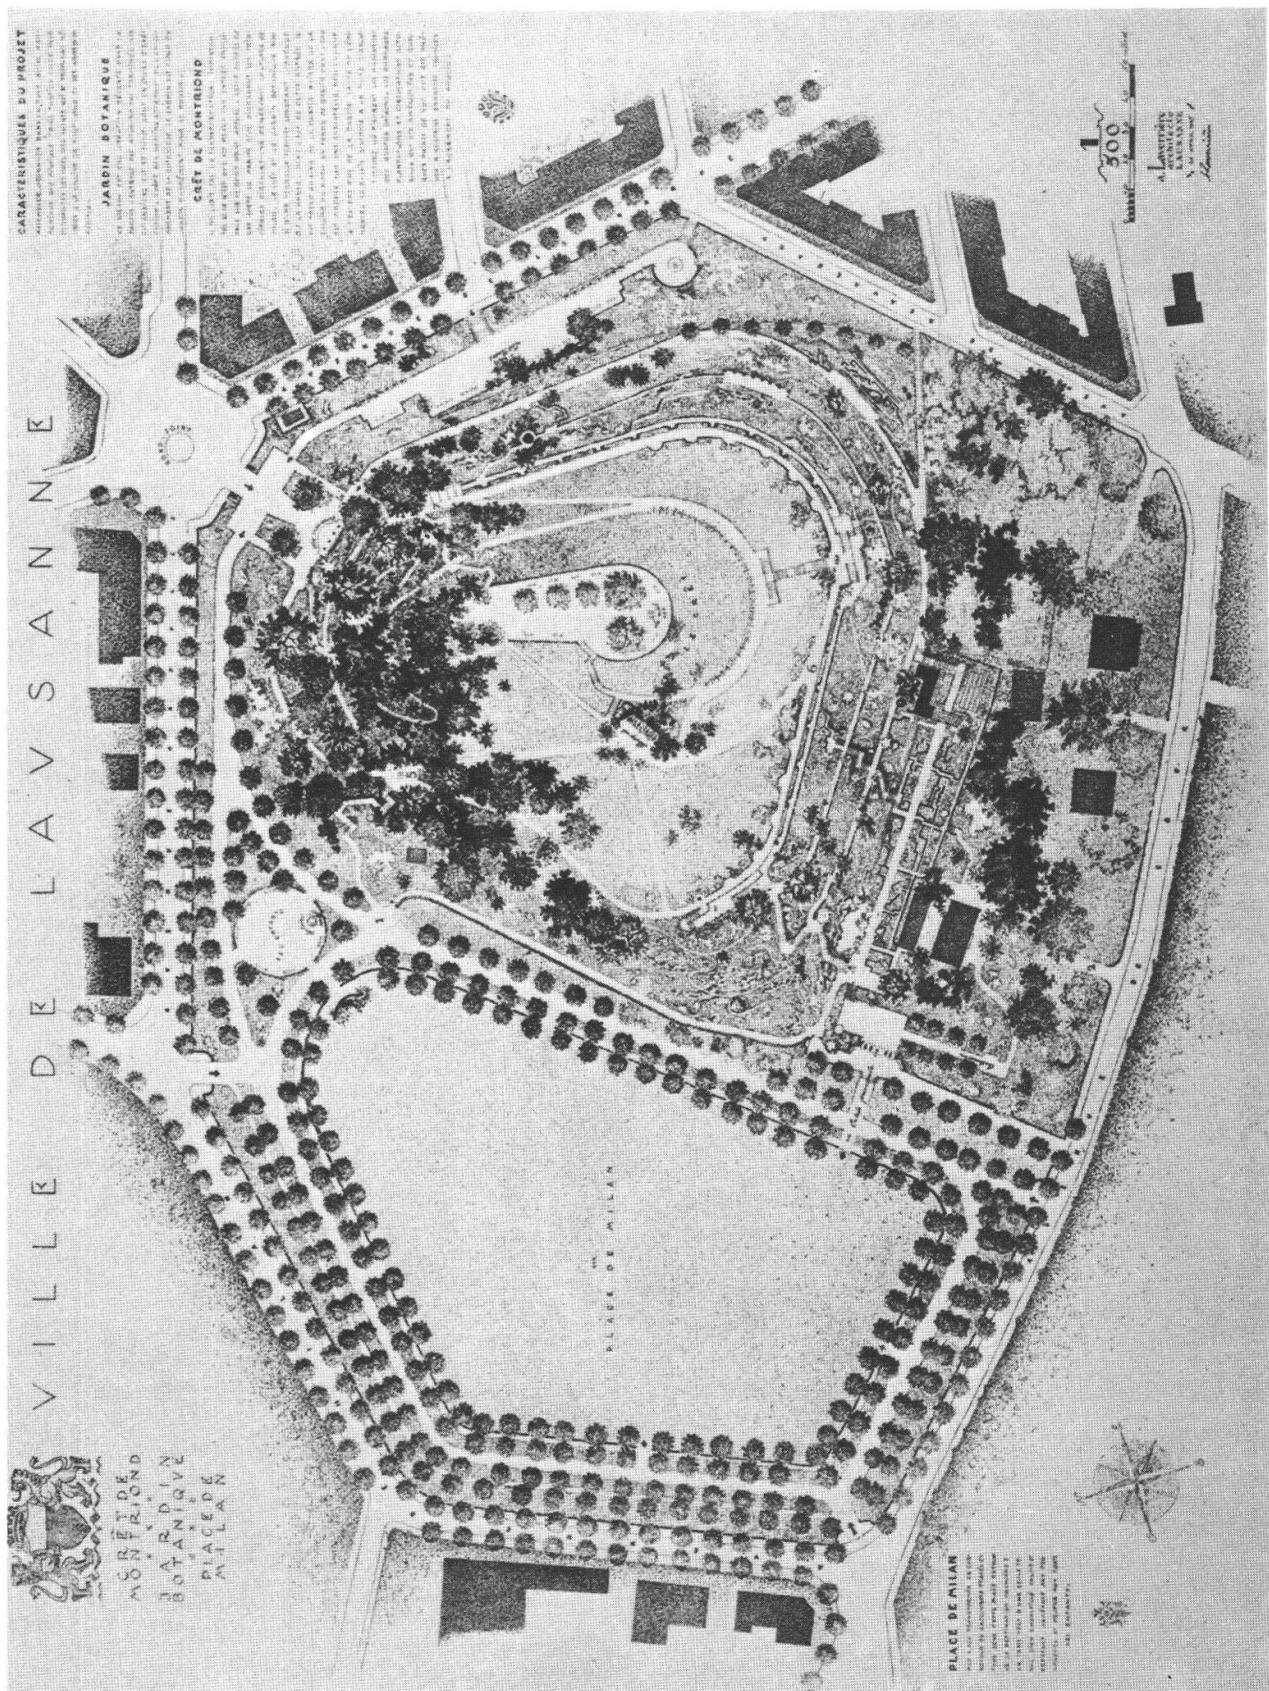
A. Laverrière, plan général de la colline de Montriond et de la place de Milan, selon L'Habitation, 1946.
